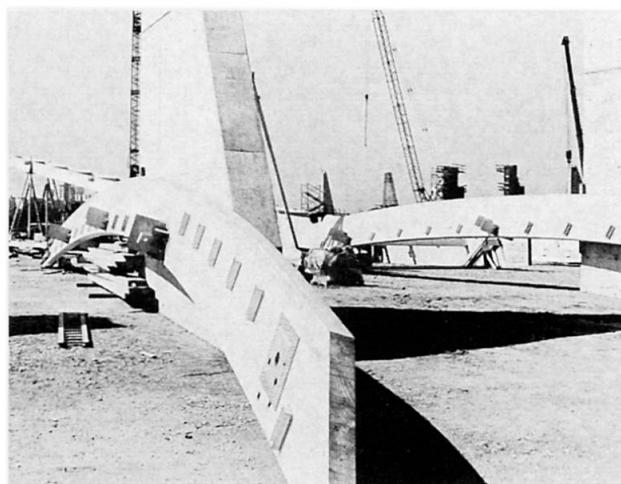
Mit den erforderlichen Anschluss- und Stossverbindungen versehen, werden auf der Baustelle jeweils 3 Brettschichtelemente zu einer 102 m langen Hängerippe montiert
